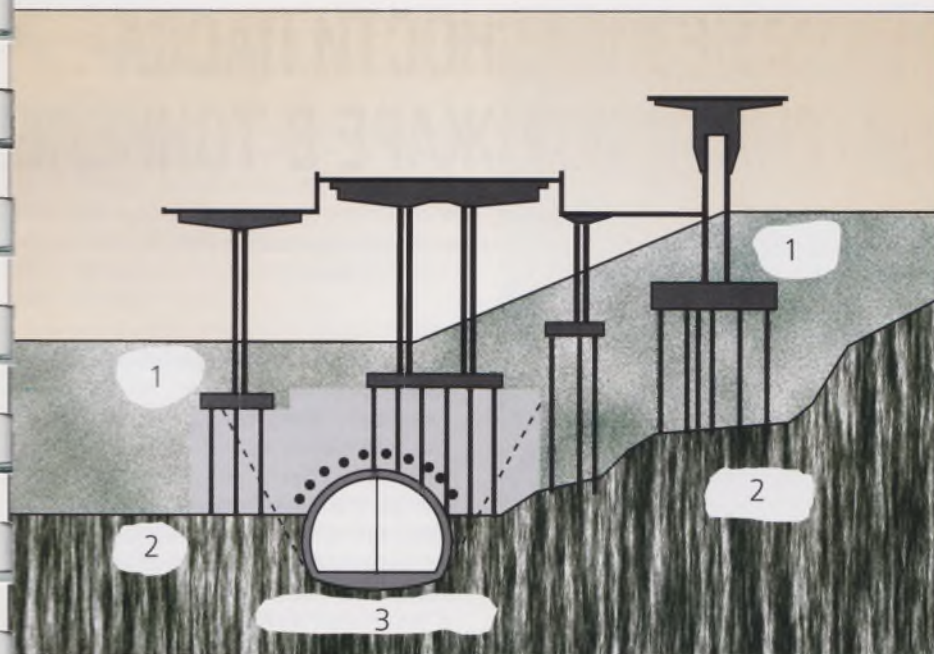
Проходка тоннеля метрополитена под свайными фундаментами опор моста:
